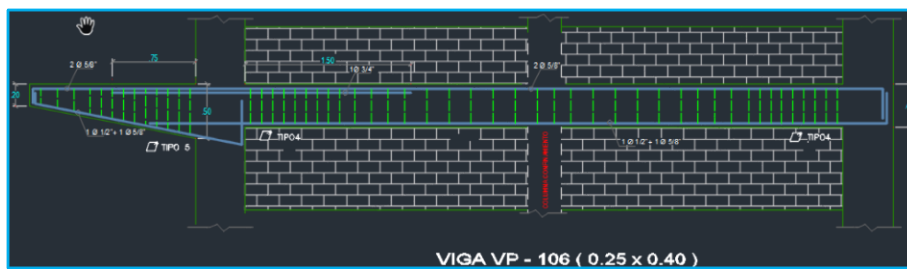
Detalle de las dimensiones de la viga VP-106 y el acero de refuerzo
